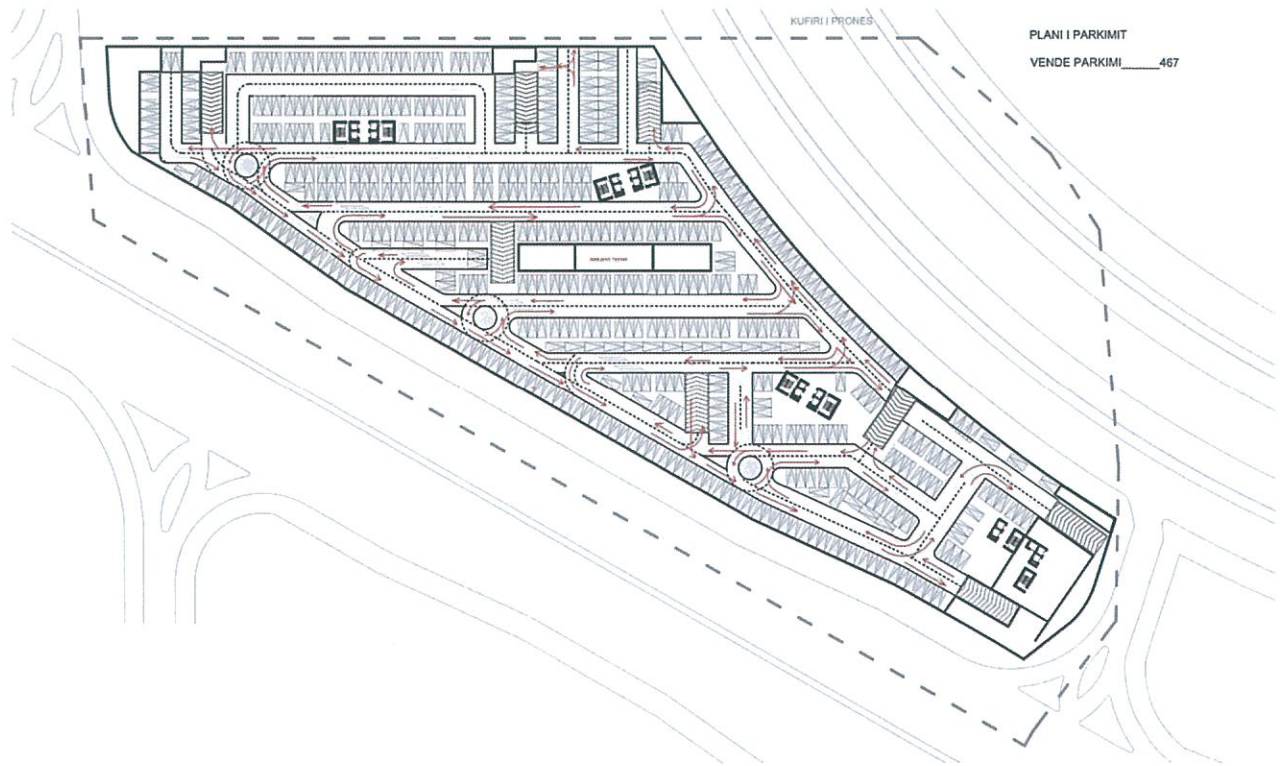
Planimetria e katit nëntokë, të parkimeve
